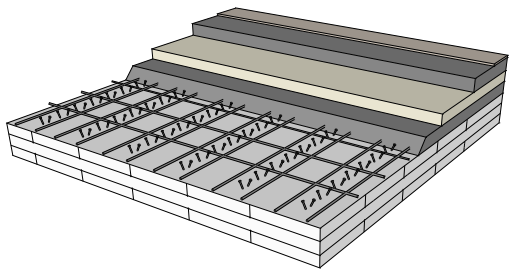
Konstruktionsschema Holz-Beton Verbunddecke
